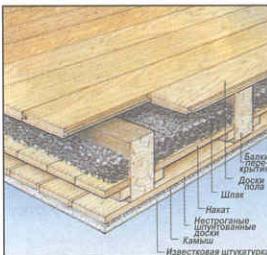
Классический пример пола мансарды. Сосновые доски покрытия пола уложены прямо на балки перекрытия без звукоизоляции. Шум от шагов по полу передается через балки на нижние элементы конструкции пола и далее вниз.
